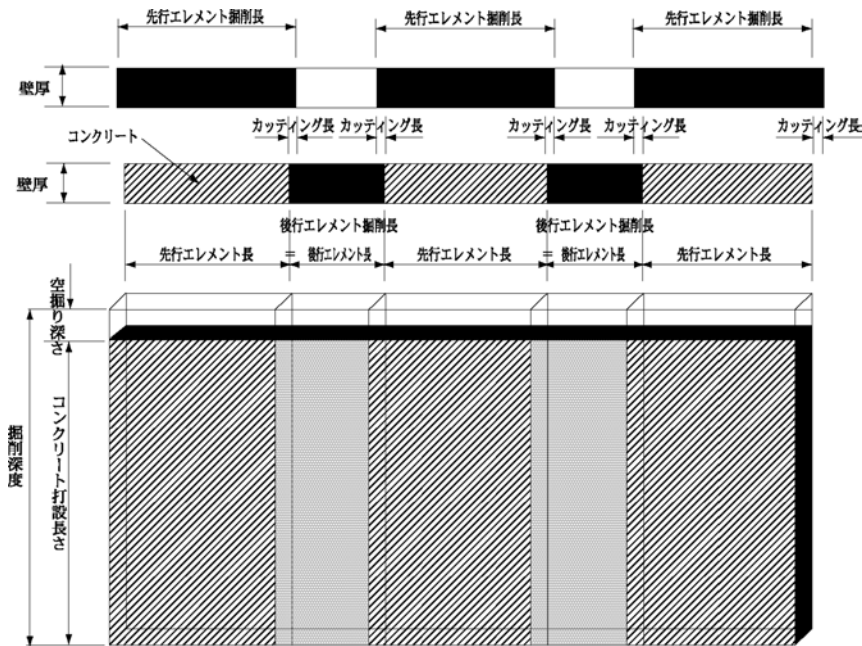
施工図（コンクリートカッティング継手方式の場合）
